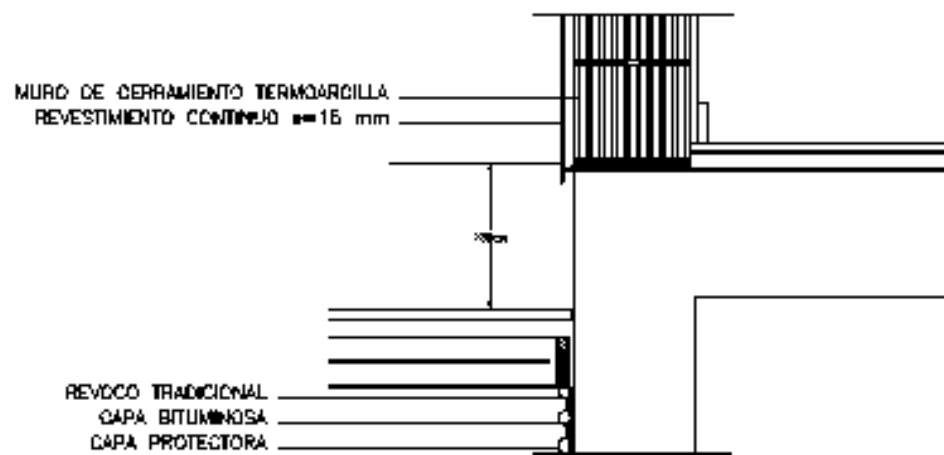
Arranques por debajo y por encima del pavimento exterior.
